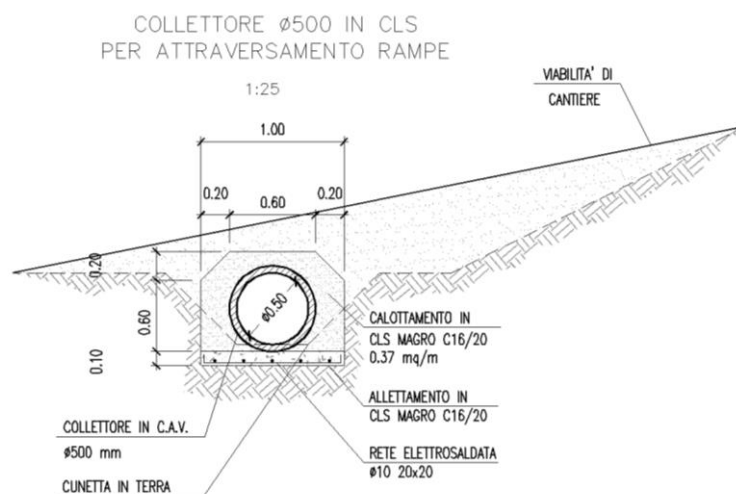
COLLETTORE D500 MM PER ATTRAVERSAMENTO PISTE DI CANTIERE
